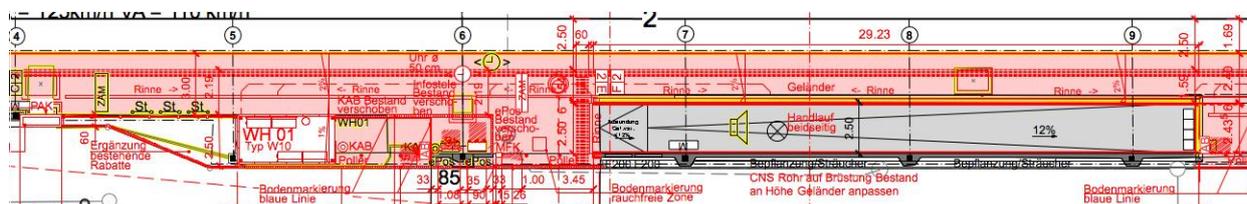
Aussenperron Rampenaufgang PU Stationsstrasse
